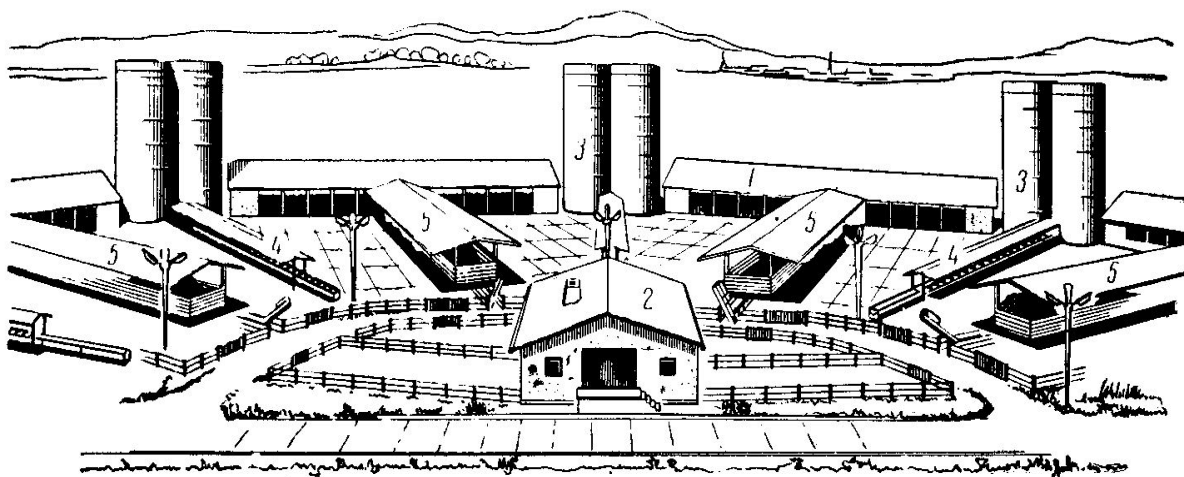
Схема генерального плану молочної ферми напіввідкритої форми на 250 корів з безприв'язним утриманням
